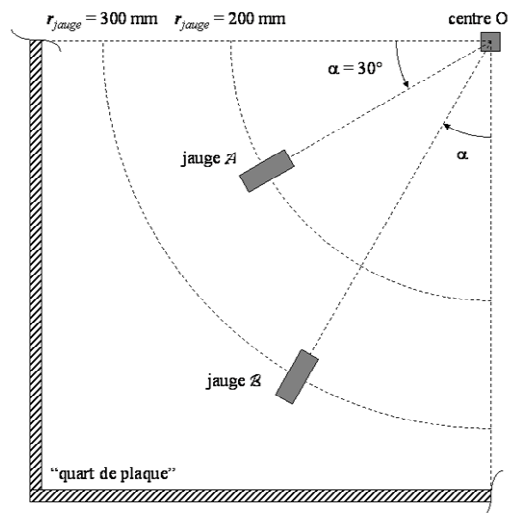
Disposition des jauges extensométriques sur la plaque
